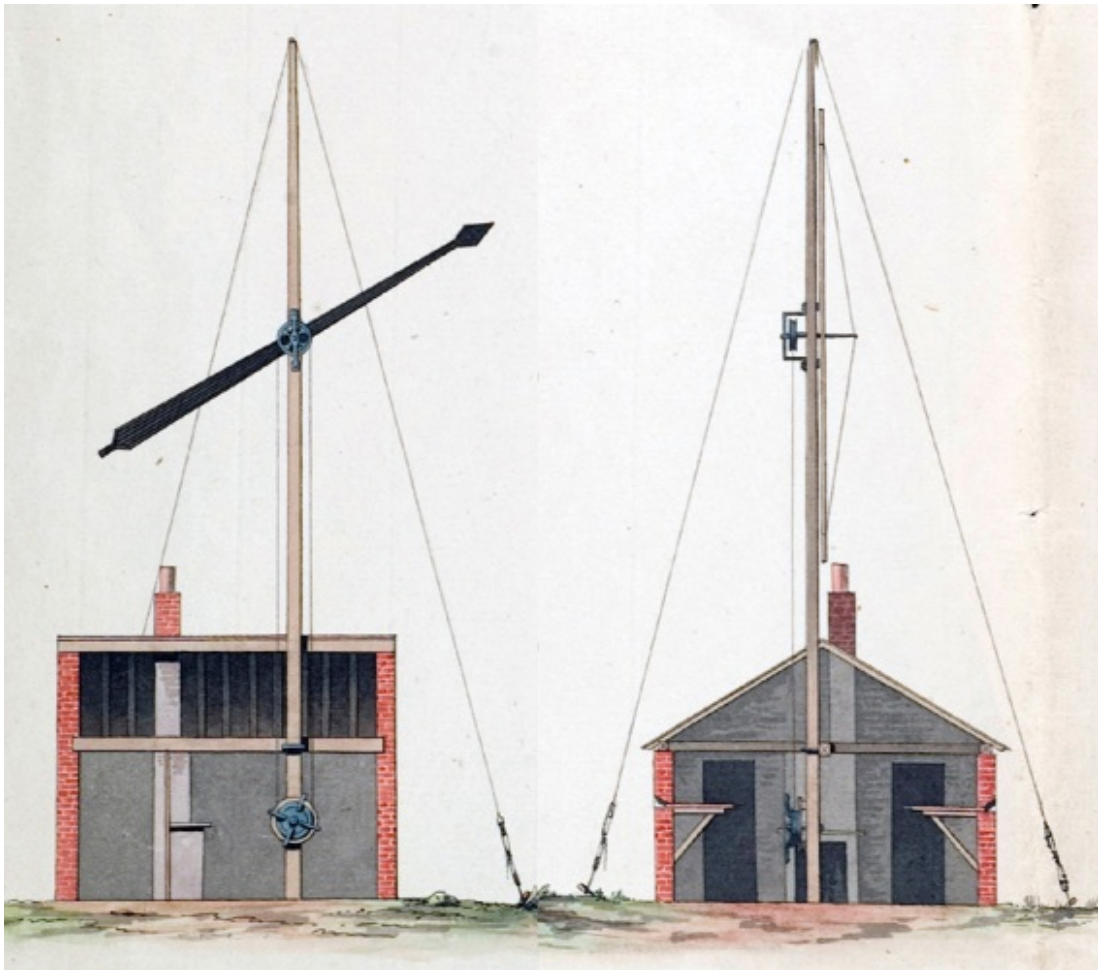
Detalle del plano presentado por Prony en su informe. Alzado y perfil.
